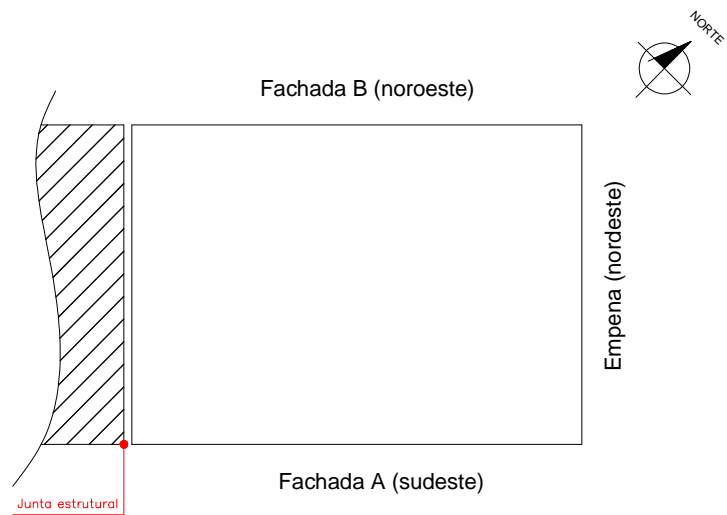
Ilustração esquemática da orientação das fachadas do edifício B.
